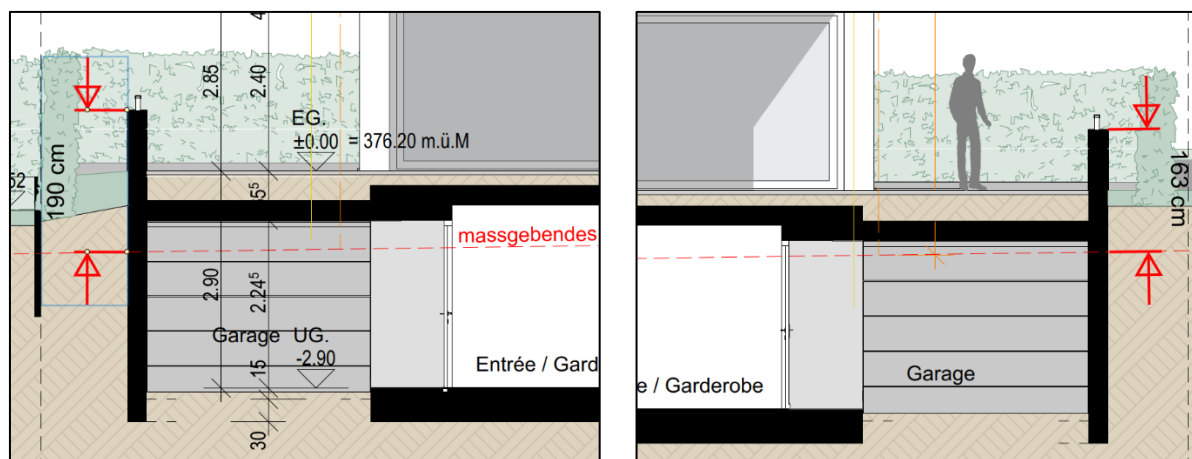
und 3: Ausschnitte aus dem Längsschnitt 03; inkl. eingefügter Messung der Garagenaussenwände
